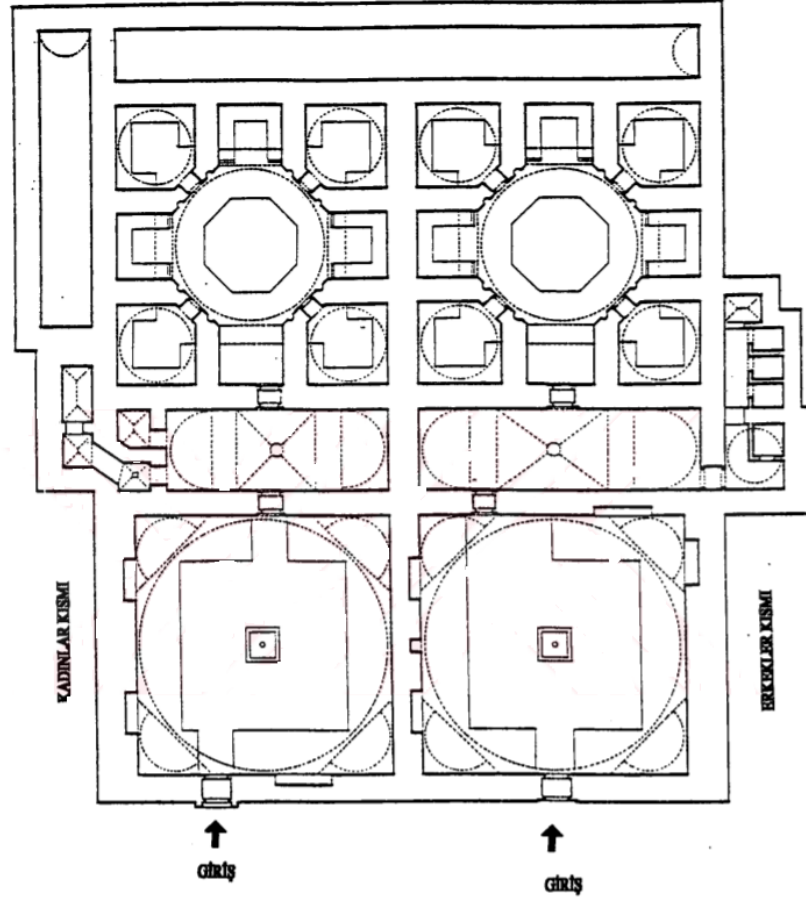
Hüsrev Kethuda Hamamı Planı ve Kesitleri– Ortaköy (A.Sami Ülgen)
